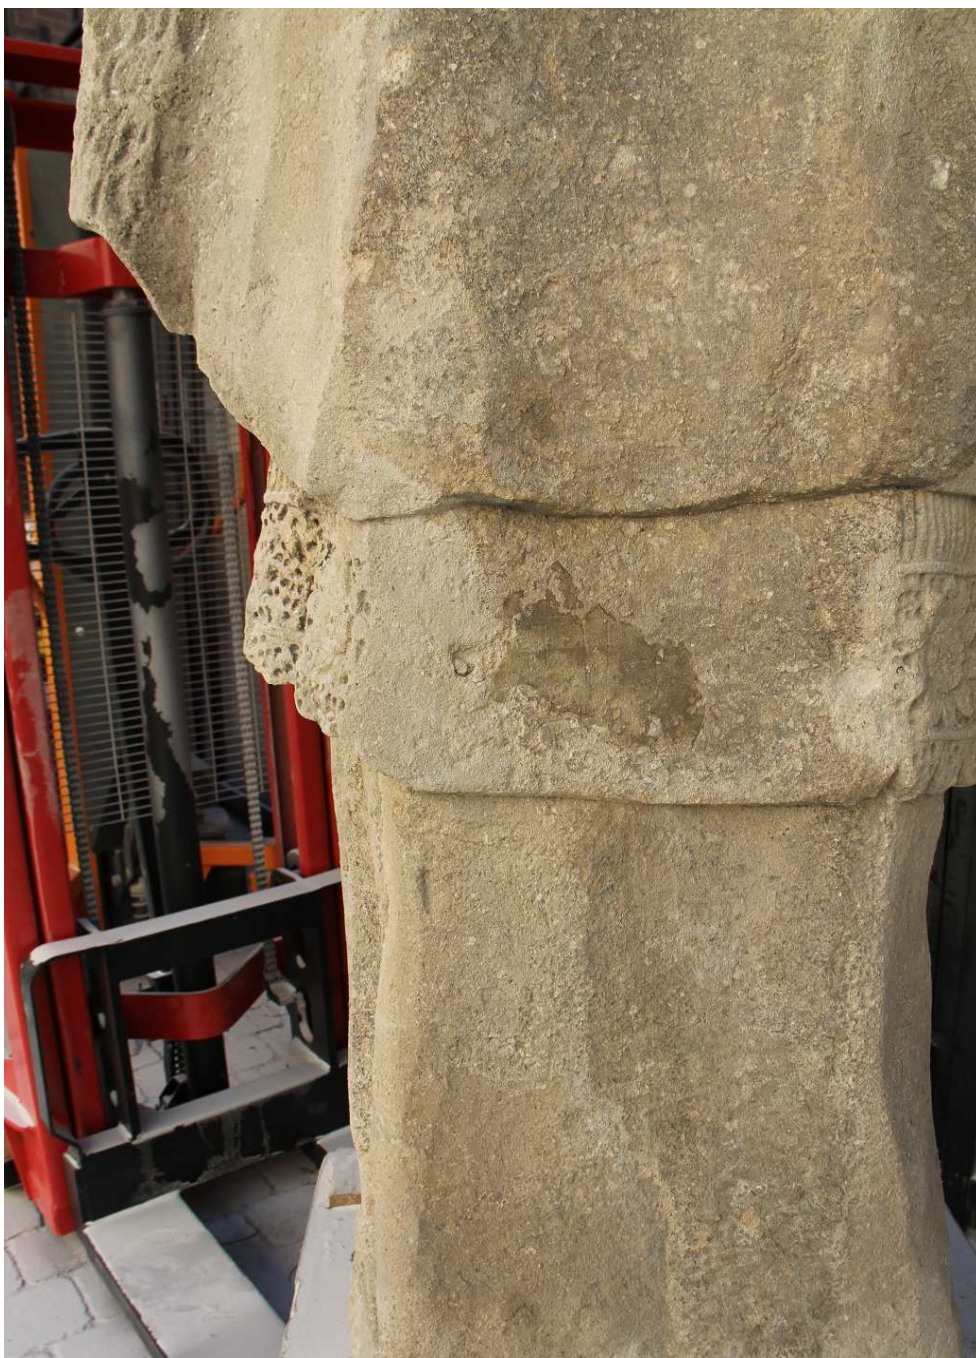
Zkorodovaná armatura z předchozího zásahu (stav před restaurováním)
